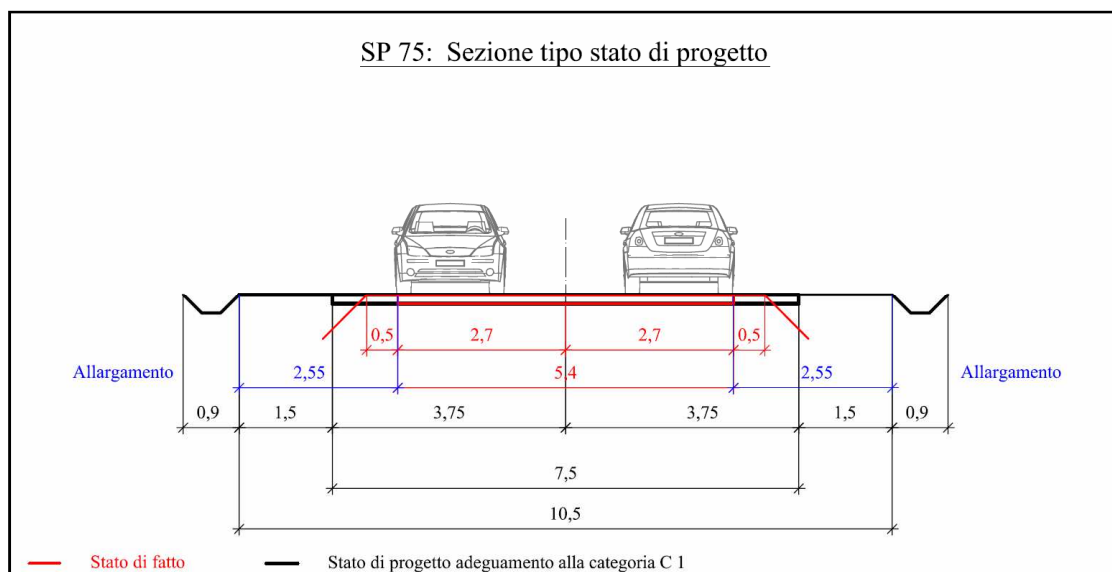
Confronto tra la sezione stradale stato di fatto e stato di progetto
